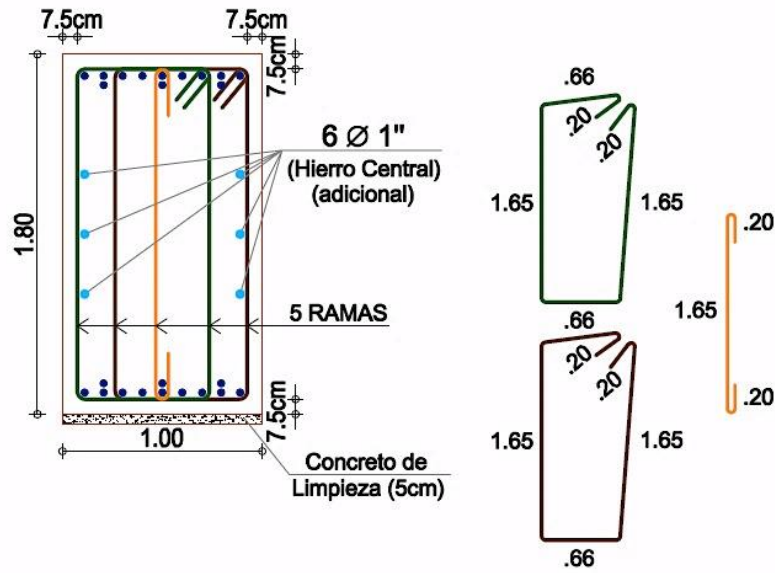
Sección transversal de una viga cemento tipo 2 (1.0 x 1.8 m).
